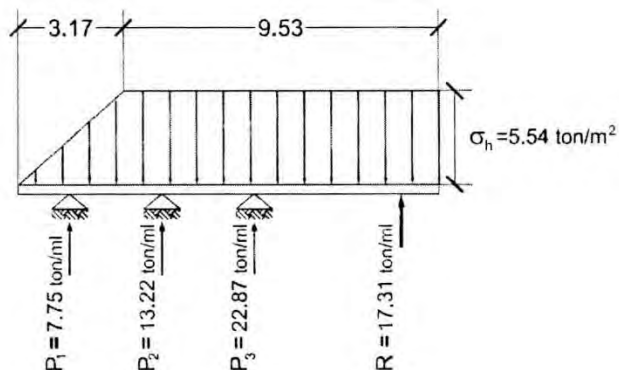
Reacciones en los apoyos de la tablestaca producidas por los empujes redistribuidos del suelo.
